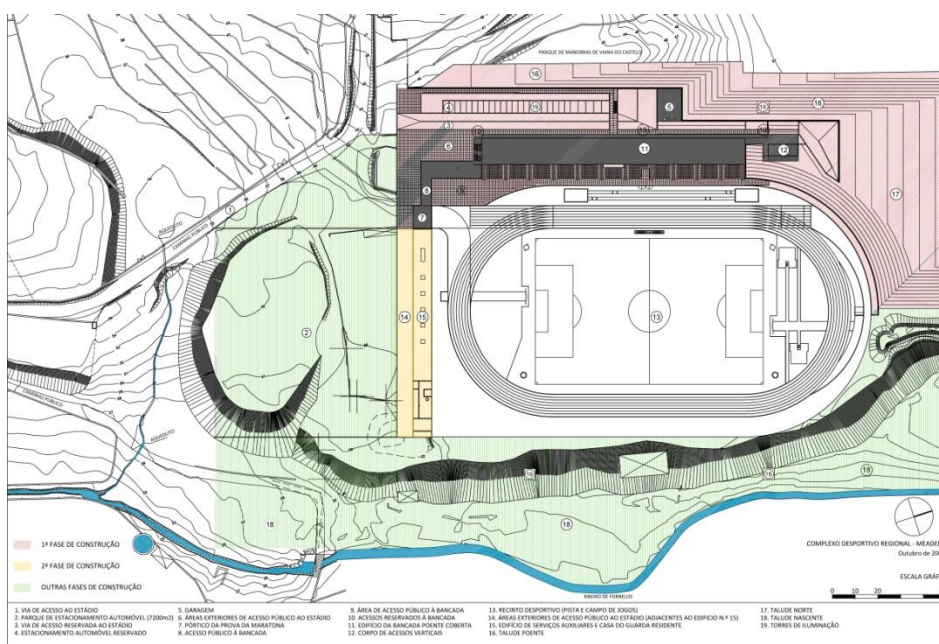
Planta de Implantação do Estádio Manuela Machado
